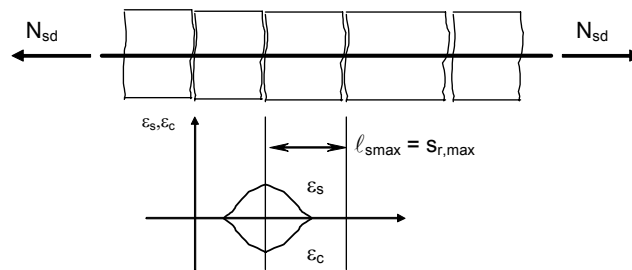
Distância entre as fissuras $l_{s,max}$ e gráfico de deformação do aço e do concreto em seção fissurada
